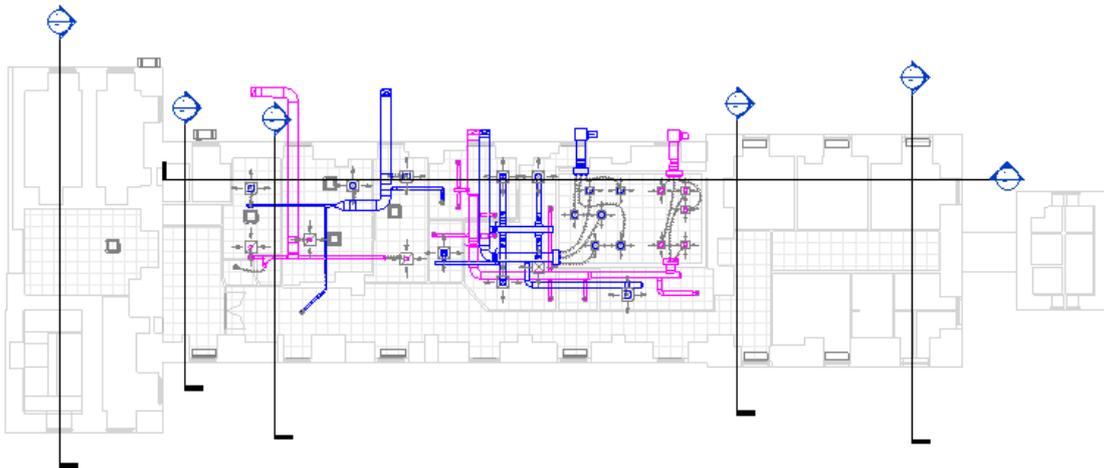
Pianta dei controsoffitti: piano inferiore Revit
